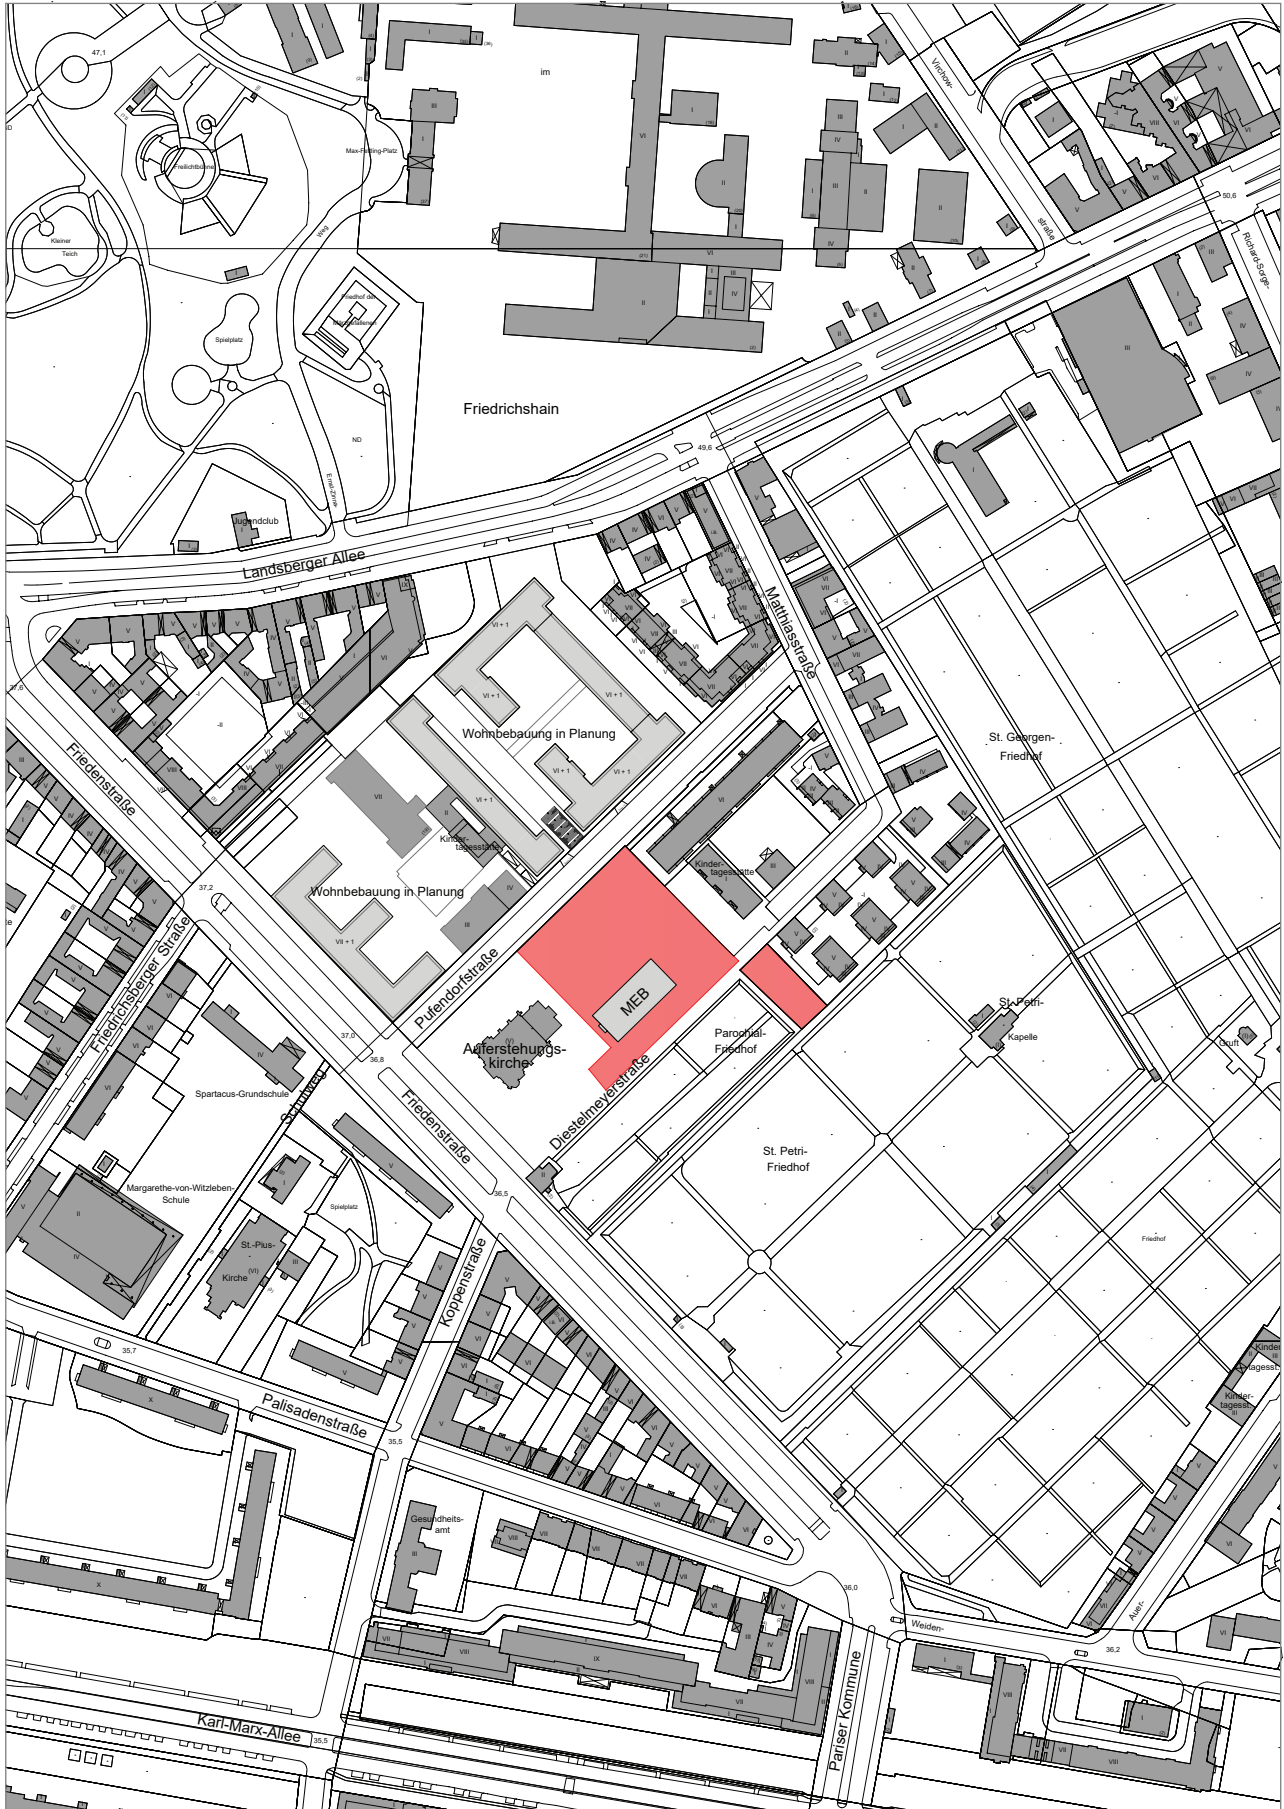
Lageplan mit Markierung des Wettbewerbsbereichs
